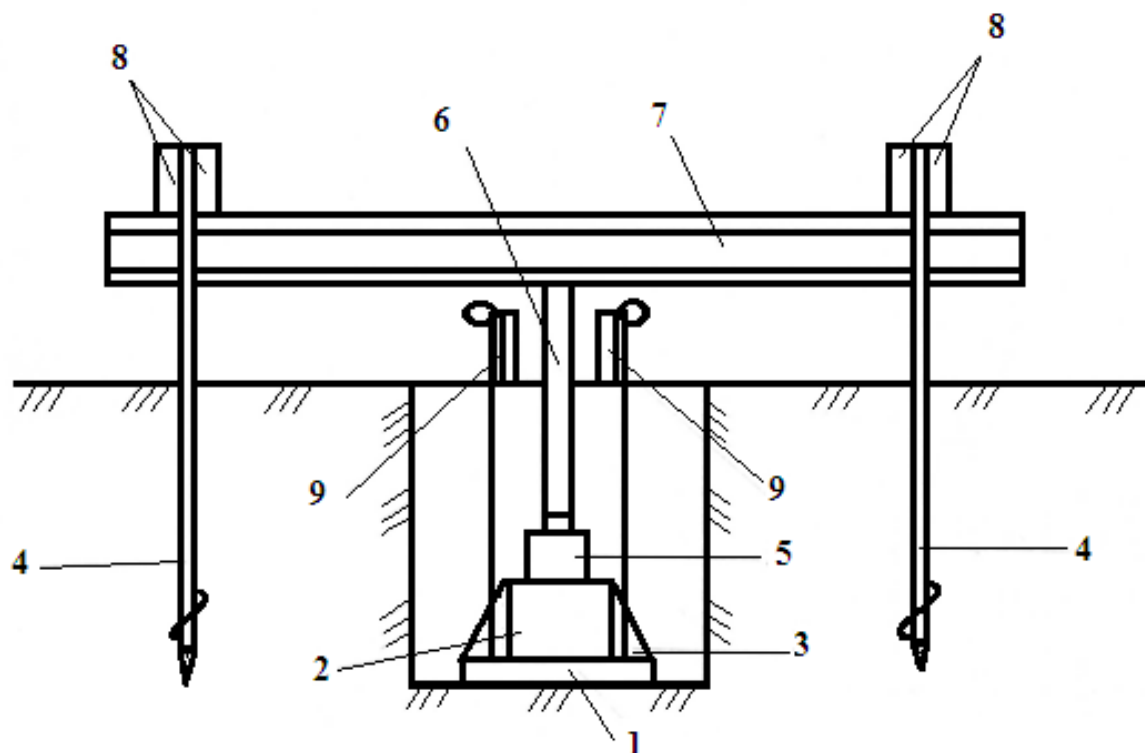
Схема установки для испытания грунта в шурфе, котловане, скважине штампом при помощи гидравлического домкрата. 1 - штамп; 2 – стол для установки домкрата; 3 - ребра жесткости штампа; 4 -анкерные винтовые сваи; 5 - гидравлический домкрат; 6 - труба-стойка; 7 - продольная упорная балка; 8 – поперечные упорные балки; 9 - реперное устройство с прогибомерами
